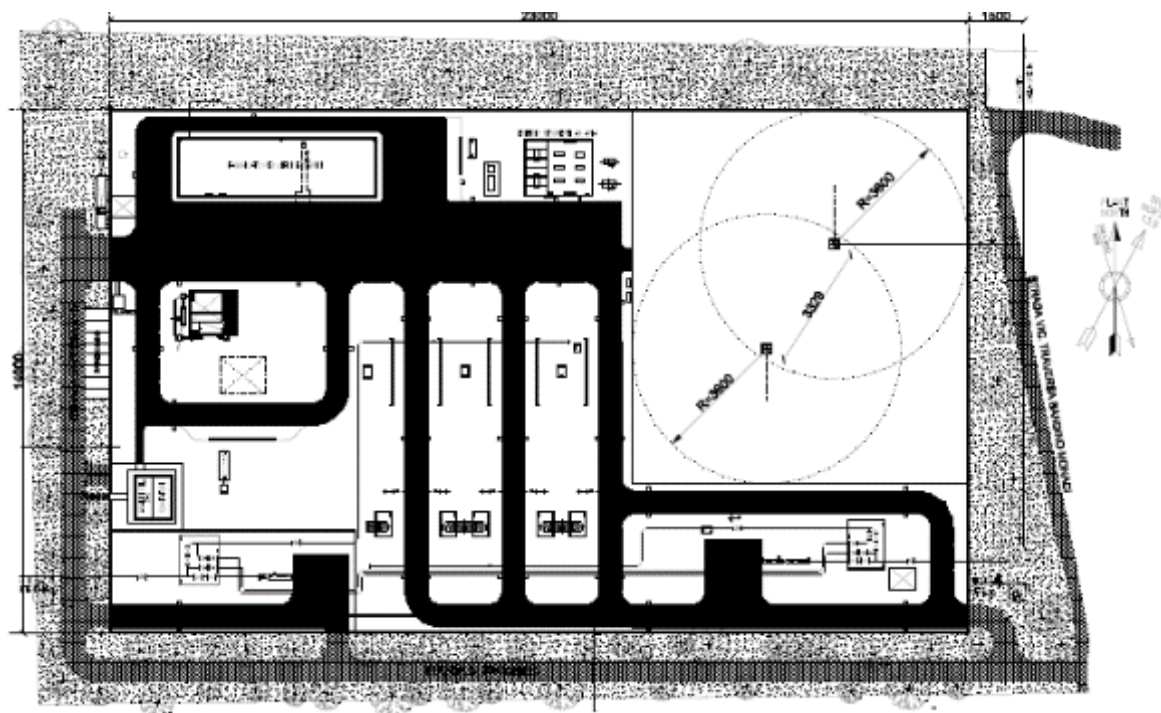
Lay-Out Stazione di Misura di Otranto
